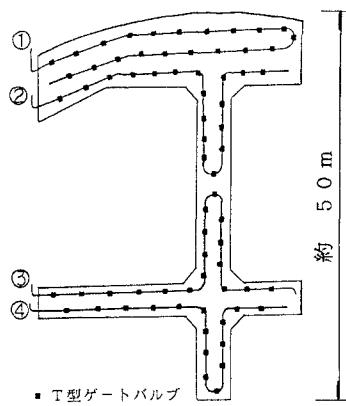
T型ゲートバルブを使用したコンクリート打設時の配管配置例
